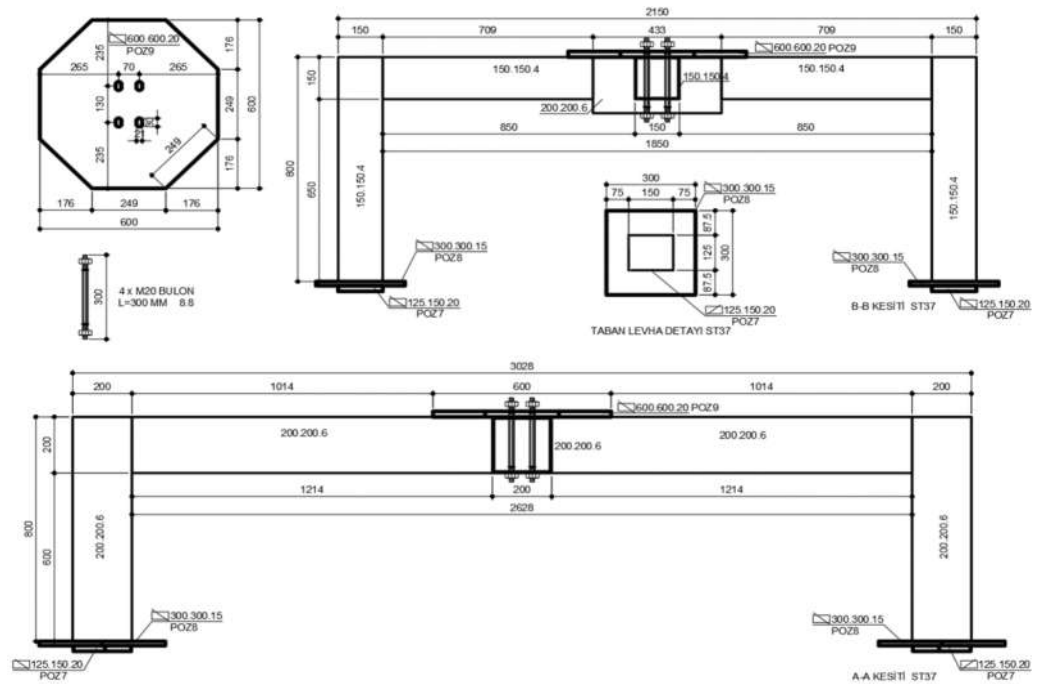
Eksenel yükleme düzeneği kolon aplikasyon planı [125].
